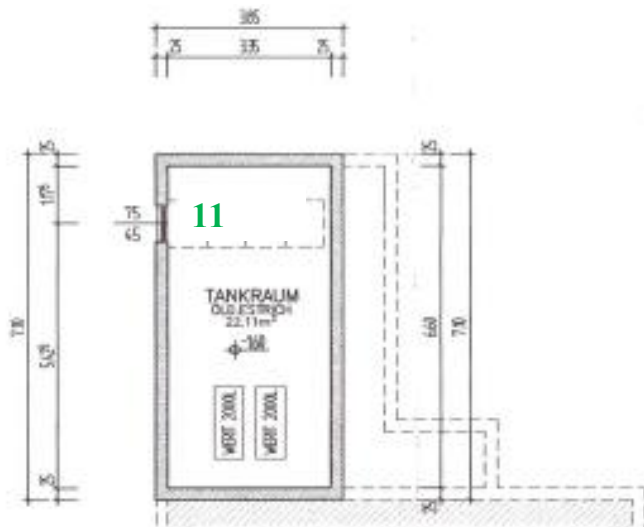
Grundrissplan Tankraum (Kellergeschoss); Quelle: Bauakt (Bestandsplan 1999)
